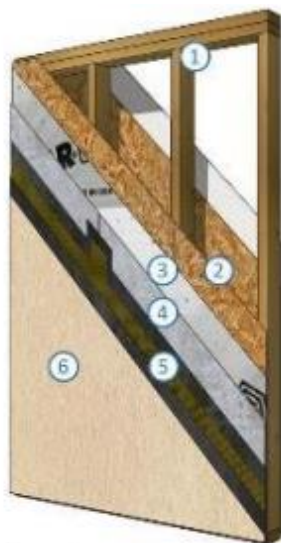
Pormenor construtivo da parede exterior [27]
